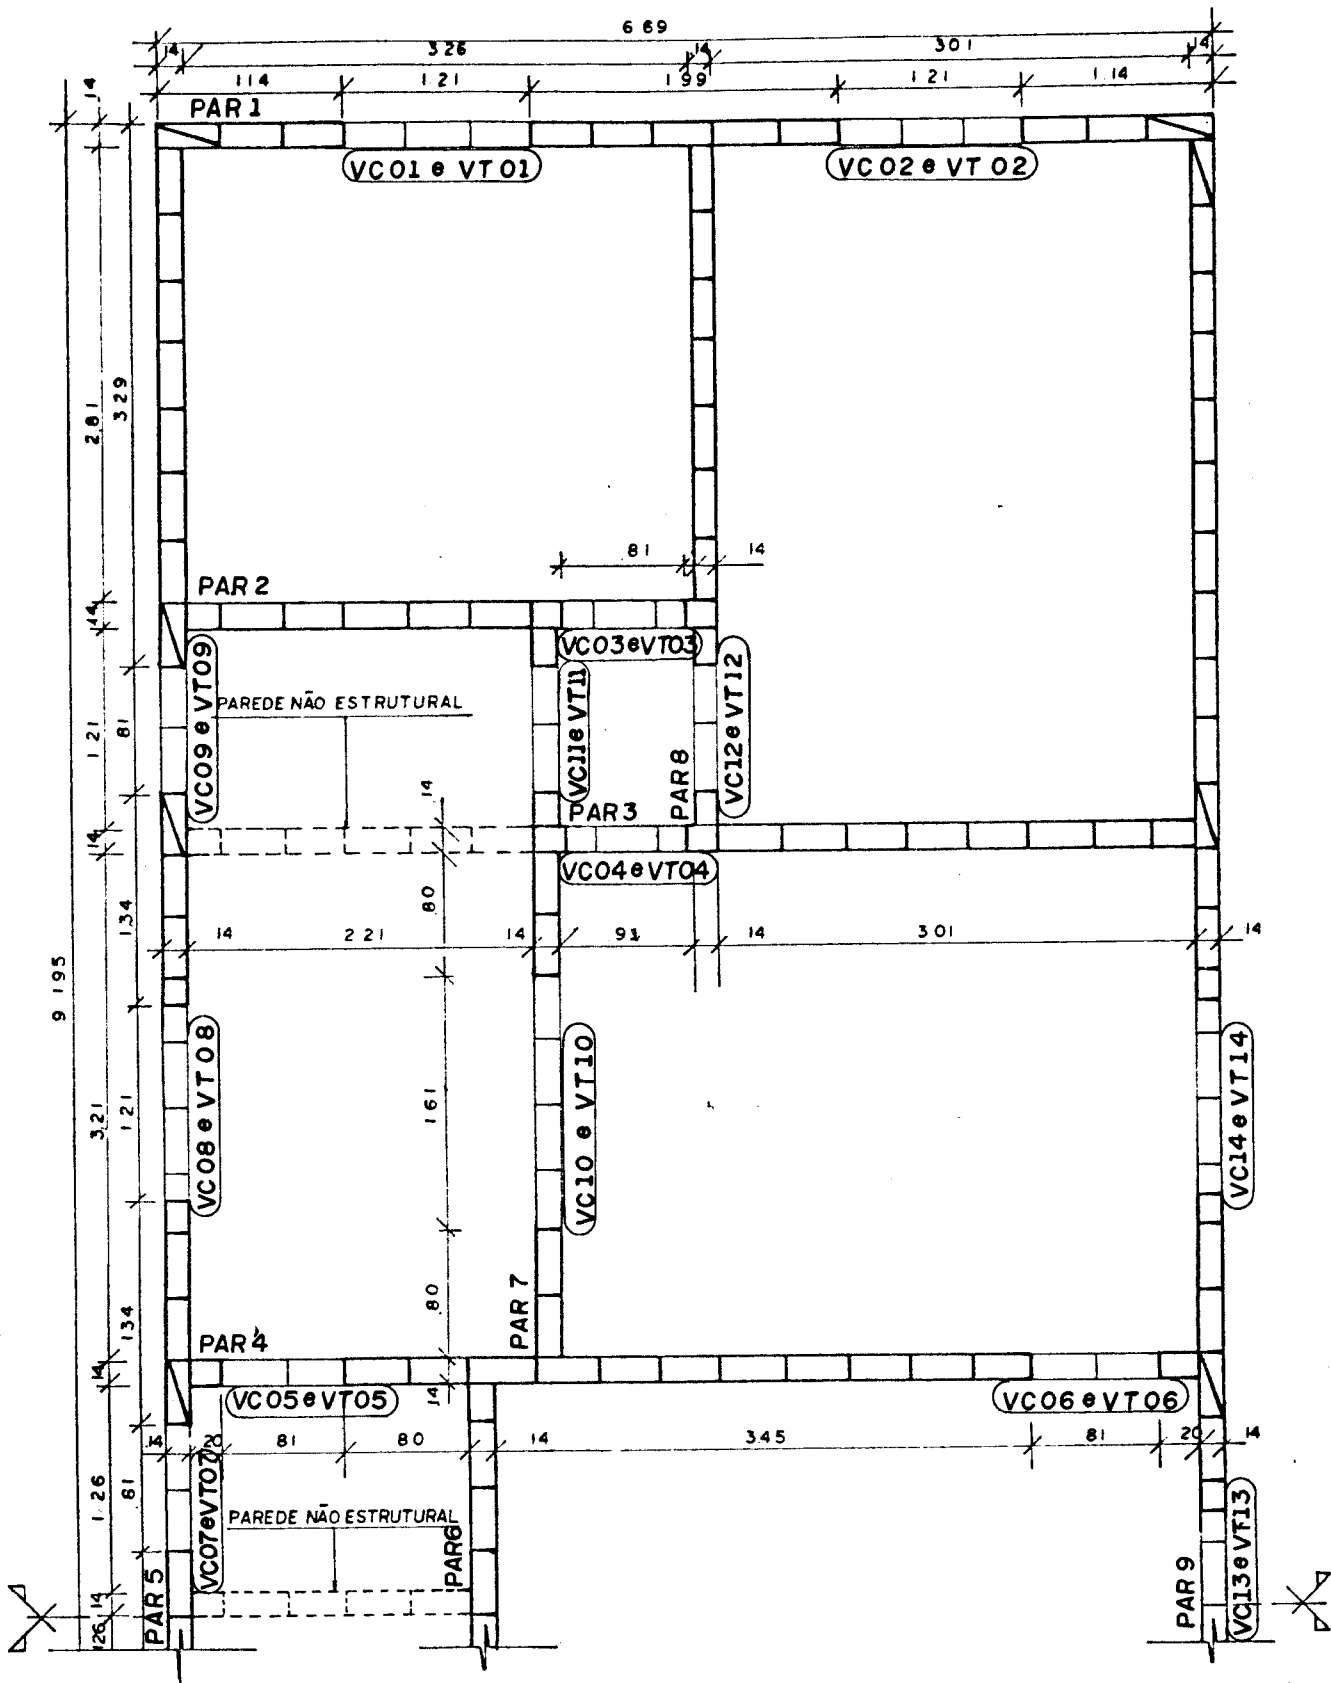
PLANTA DO PAVIMENTO TIPO- FIADA ÍMPAR.
